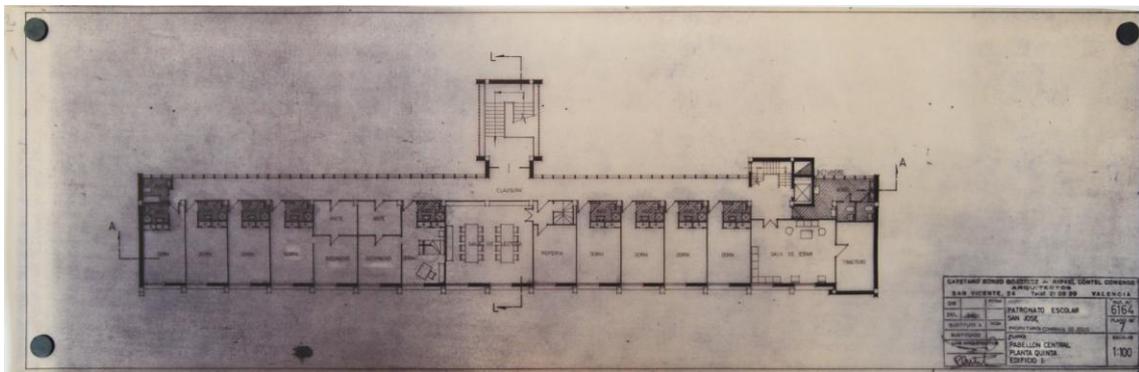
Planta cuarta. *Archivo Escuelas San José.
